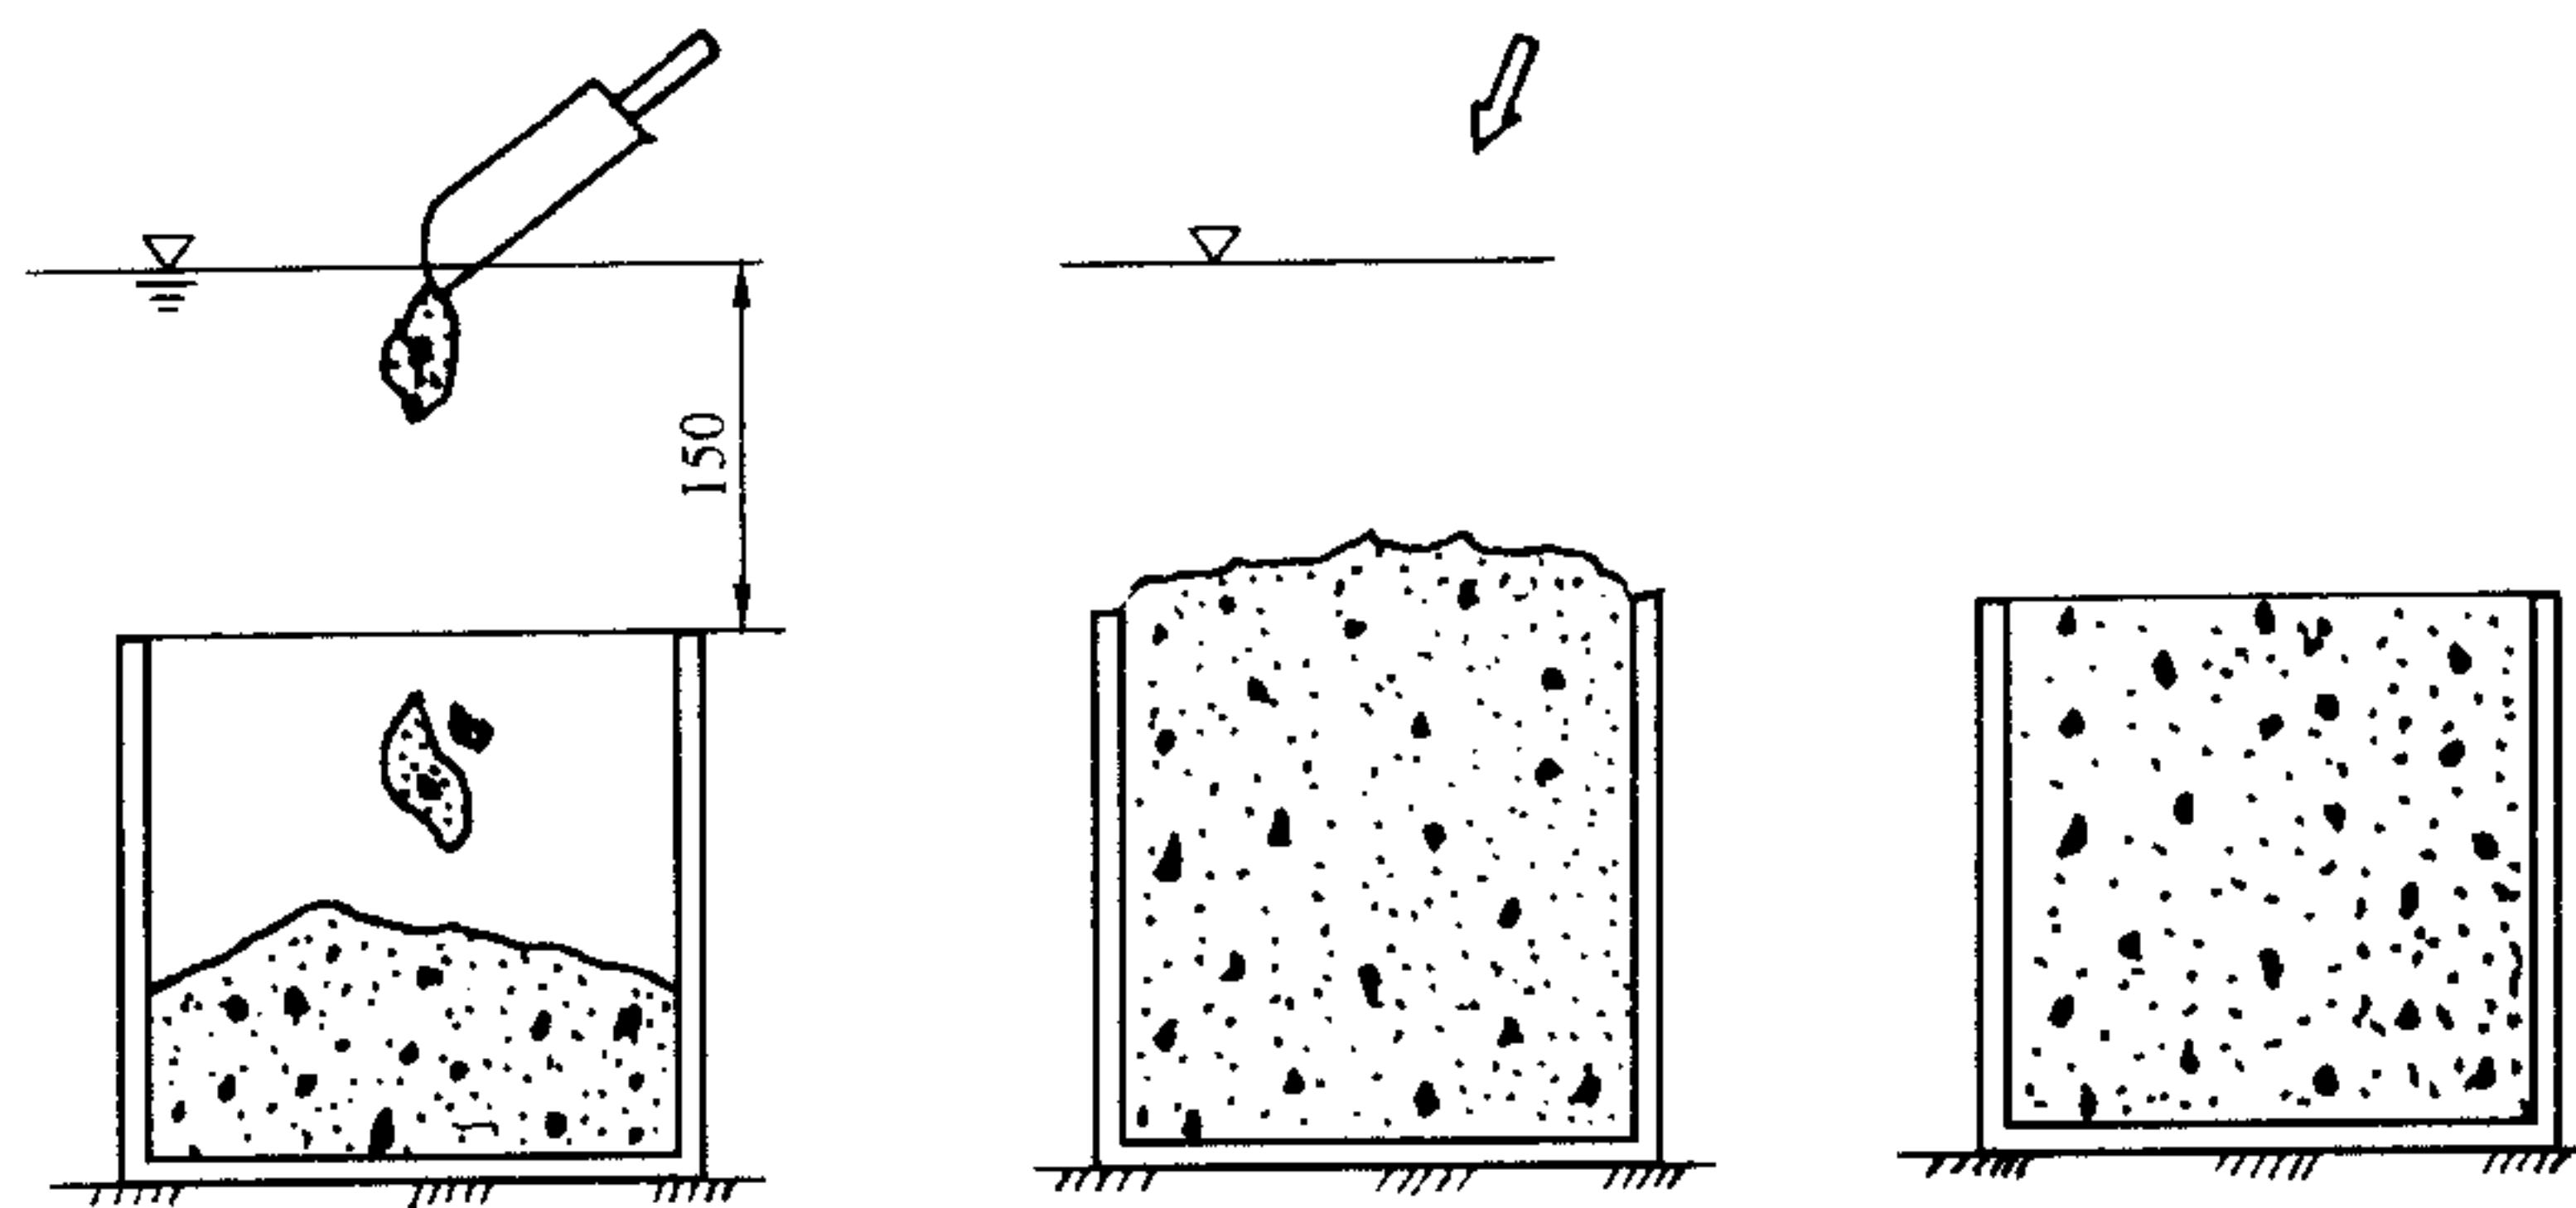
水下混凝土浇注方法 (单位: mm)
